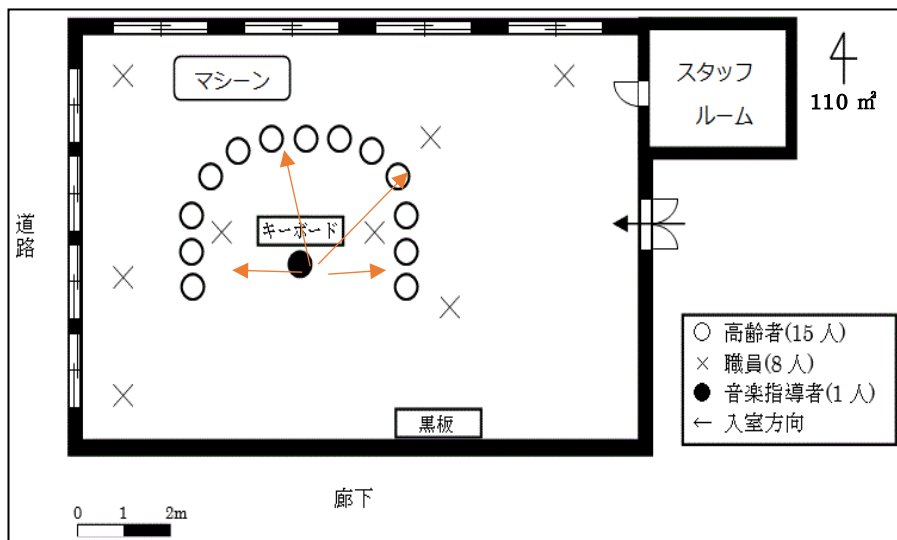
半円形型の配置図 1F 平面図 筆者作成
